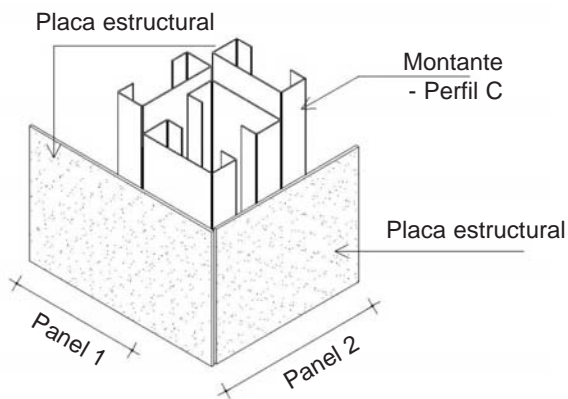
Encuentro entre dos placas estructurales en esquina.
